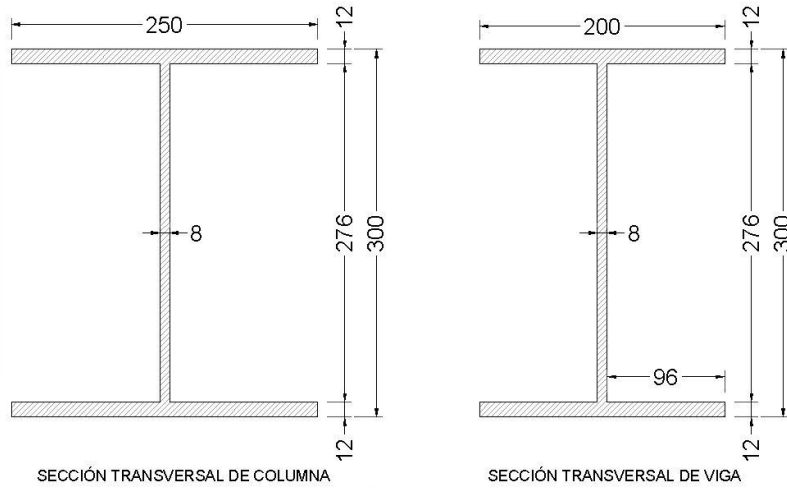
Sección transversal de columna y viga respectivamente, dimensiones en mm.
